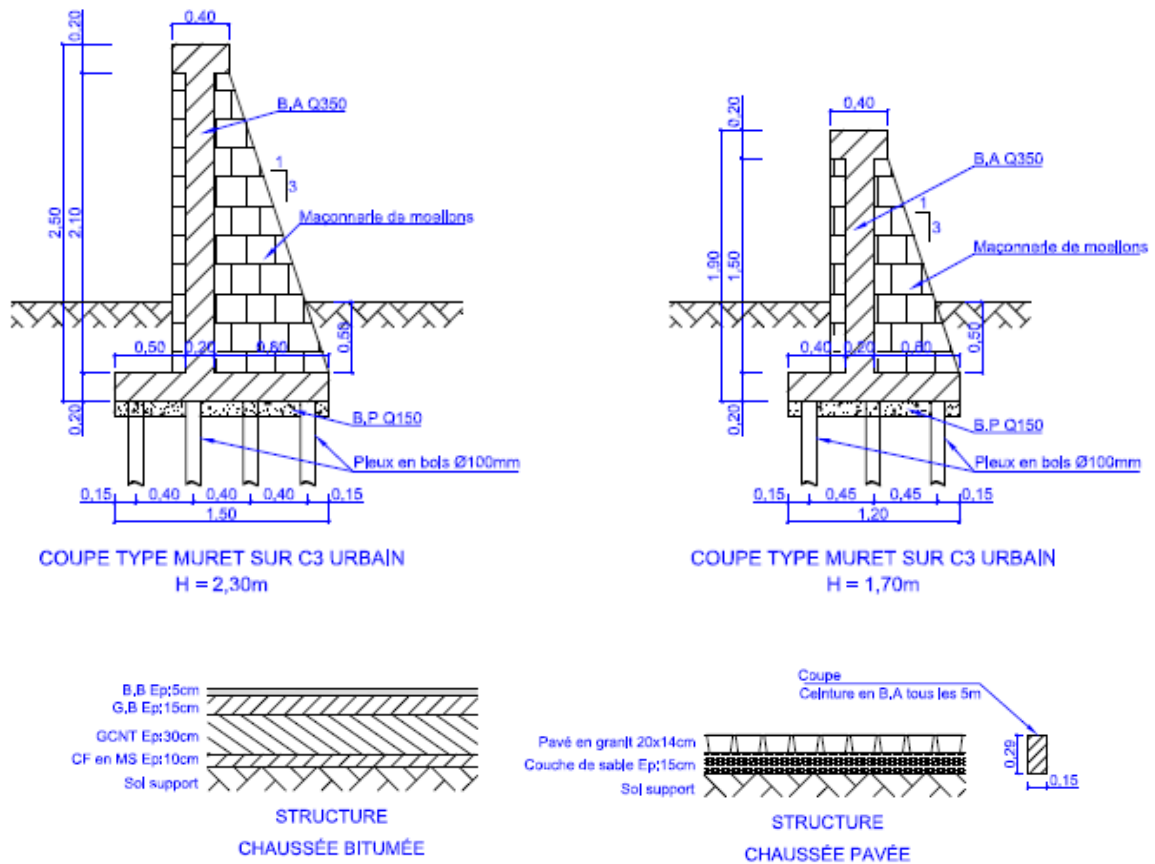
Plans types des murets de soutènement et chaussées envisagés
